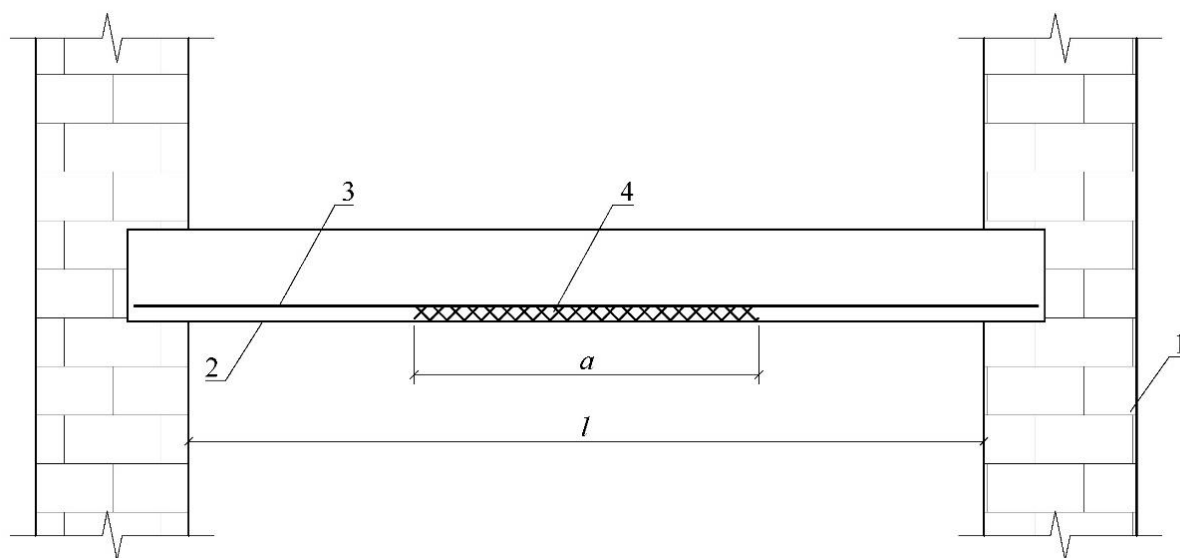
Схема дефекта - отслоение защитного слоя железобетонной плиты перекрытия: 1 – вертикальная несущая конструкция (стена); 2 – плита перекрытия; 3 – арматура в растянутой зоне плиты перекрытия; 4 – зона отслоения защитного слоя; l – длина растянутой зоны конструкции (принята условно как размер «в свету»), м; a – длина зоны отслоения защитного слоя, м.
